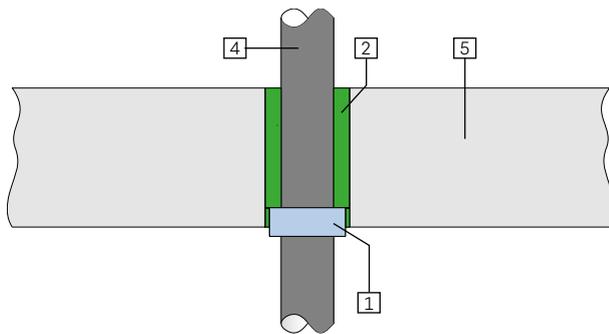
Sellado cortafuego para tubos poliméricos en construcciones de techo macizo
